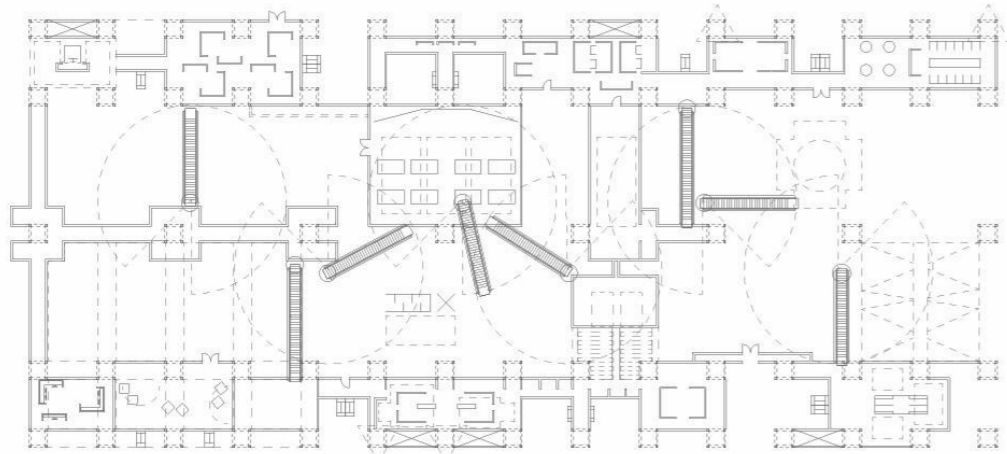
| Planta del Fun Palace (plano realizado por Madeline Entrikin).
